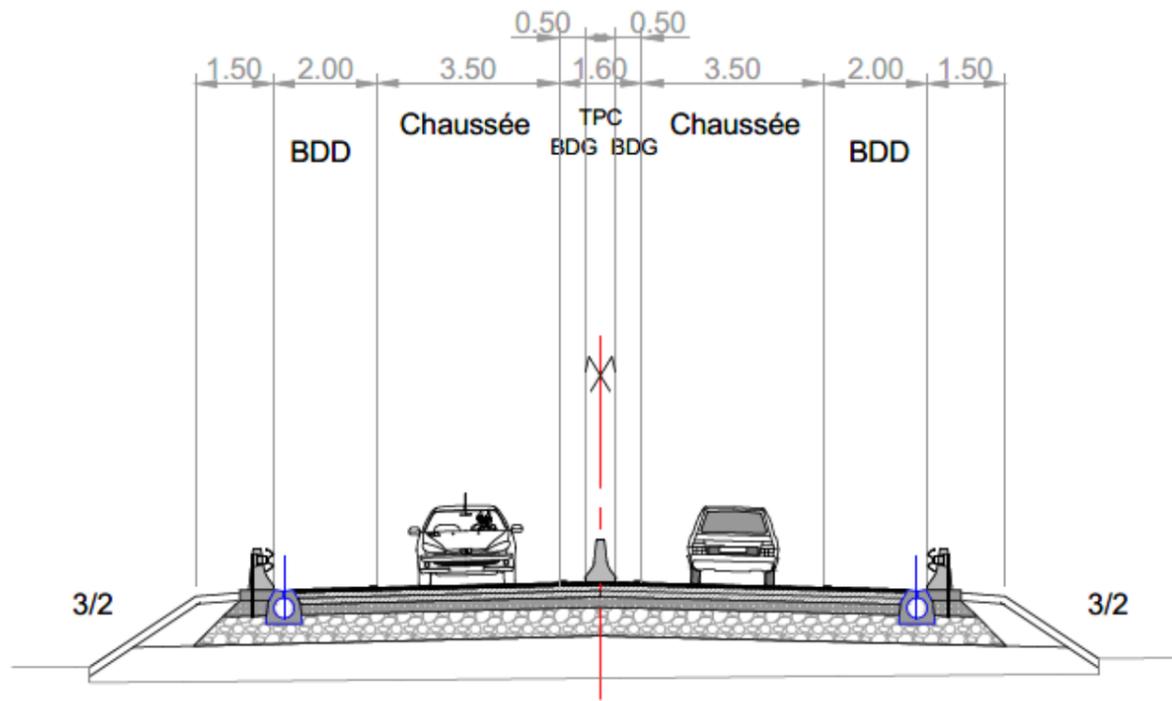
profil en travers type d'une bretelle bidirectionnelle (bretelle de l'échangeur M6d)
